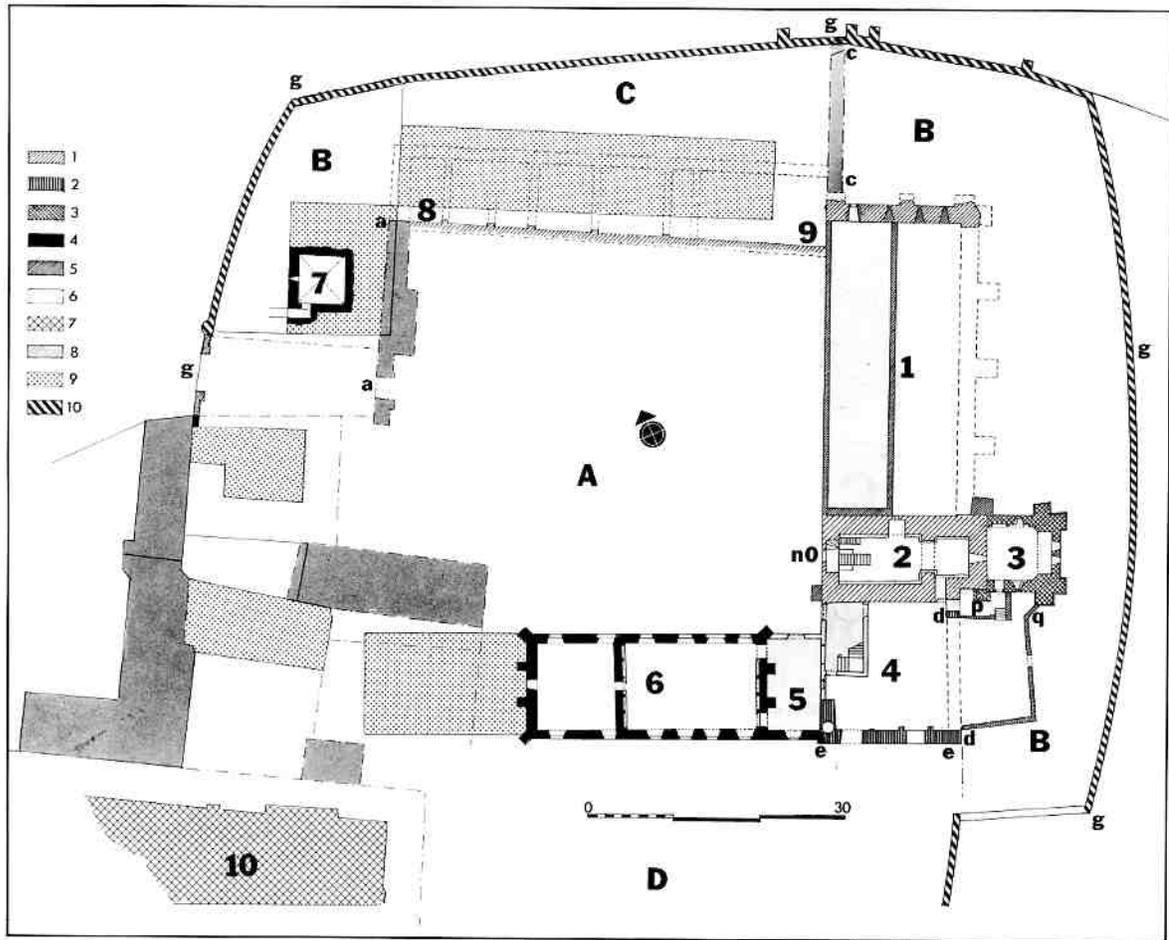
PLAN DU PALAIS AU REZ-DE-CHAUSSÉE, DANS SON ÉTAT EN 1963,
